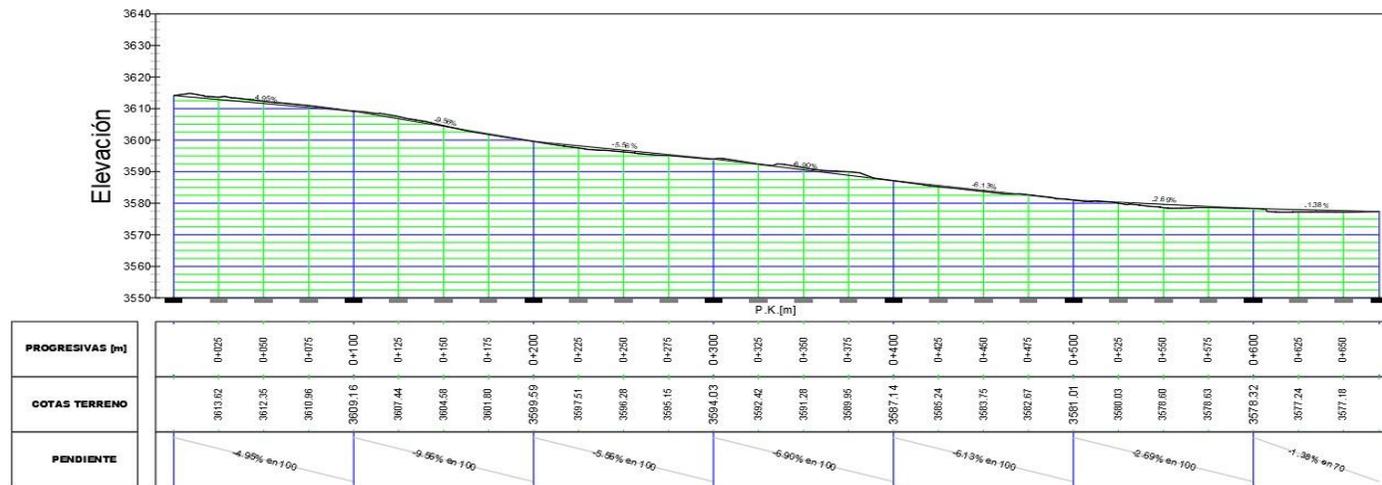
6 Perfil de elevación del eje de vía principal. (Elaboración propia, 2021)
